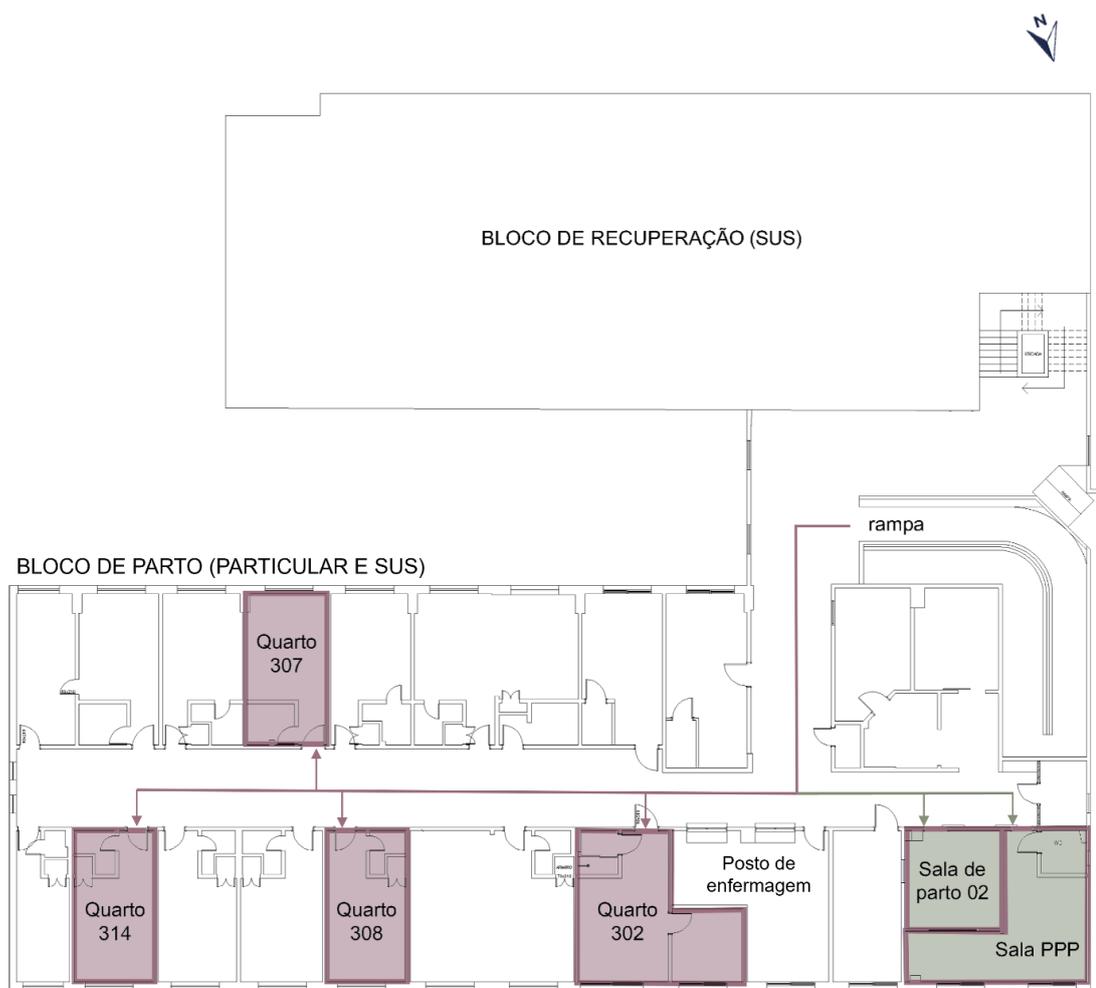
Planta baixa do terceiro andar do HU (maternidade).
